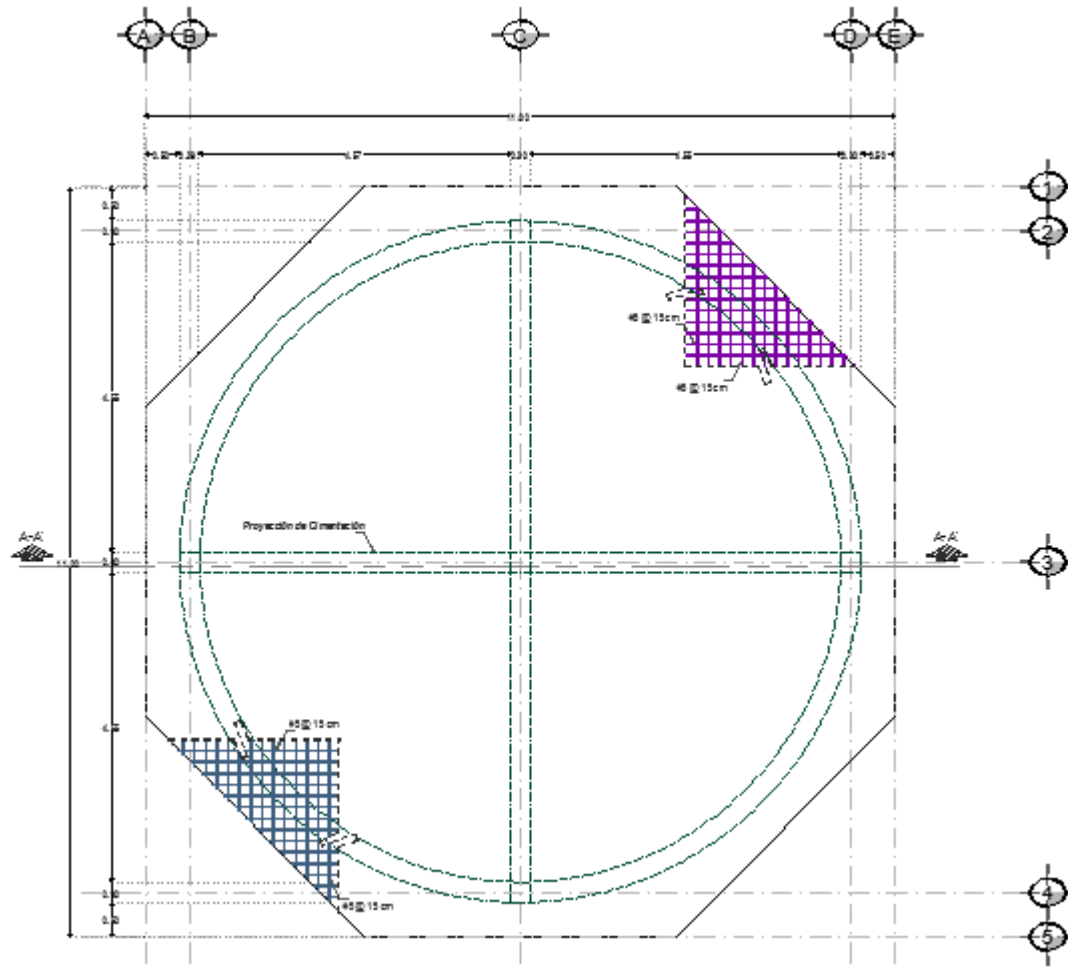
Arreglo de cimentación del tanque de agua del sistema contra incendio (Vista en planta)
